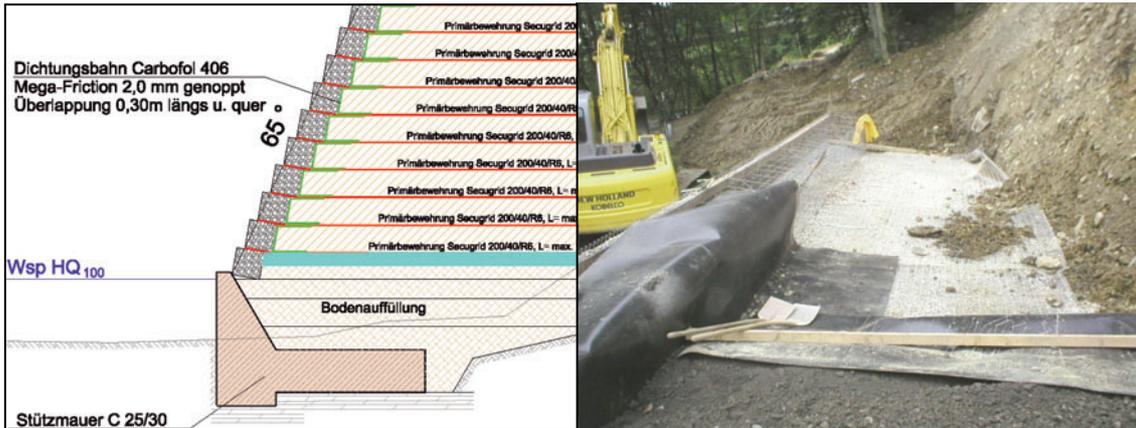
Systemquerschnitt (Ausschnitt) und Verlegung der Kunststoffdichtungsbahn im Frontbereich der bewehrten Erde
